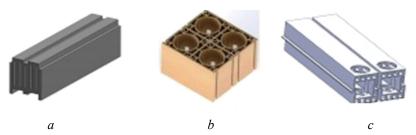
Отдельные элементы универсального набора: a – фундаментный блок; b – стеновой блок; c – балка перекрытия
